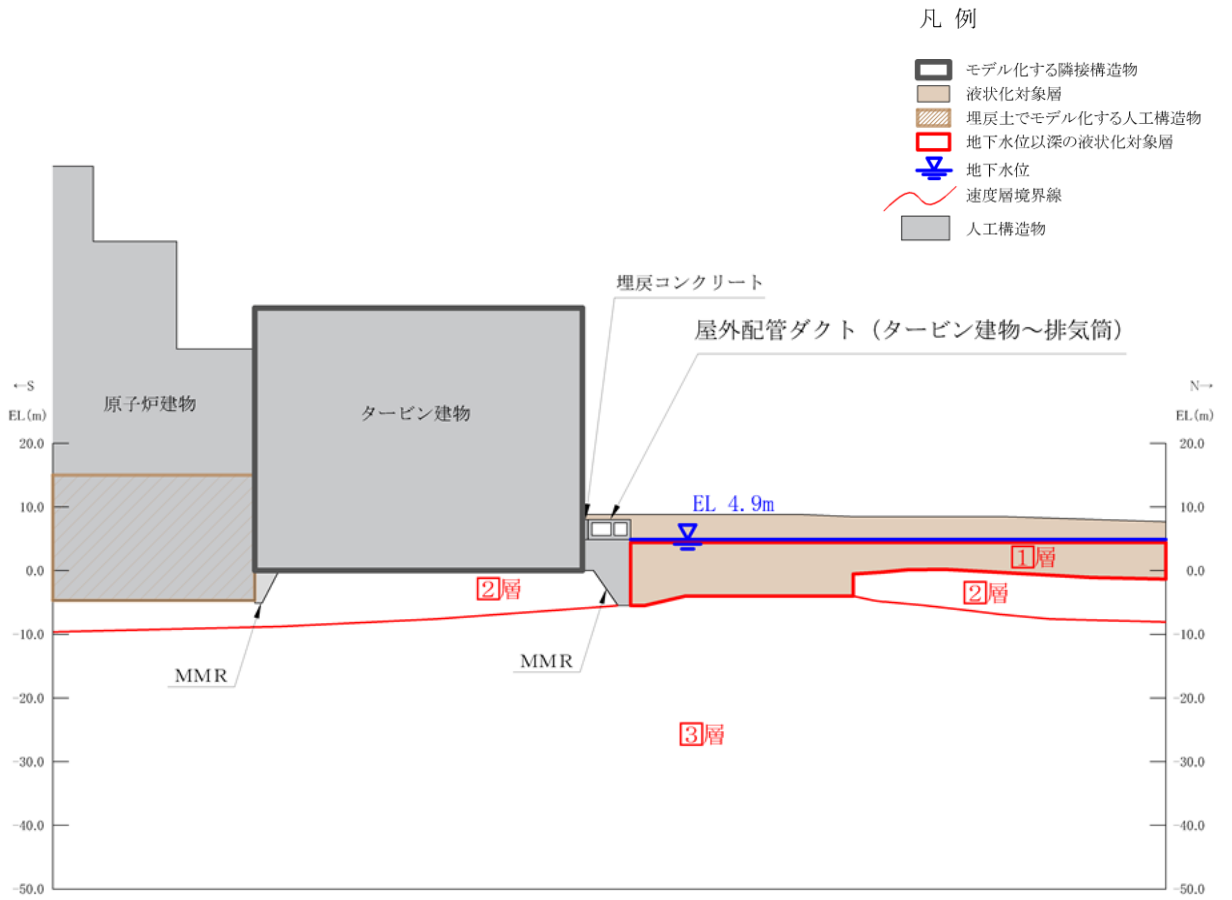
一体化部 地震時荷重算出断面図 (A-A 断面)
